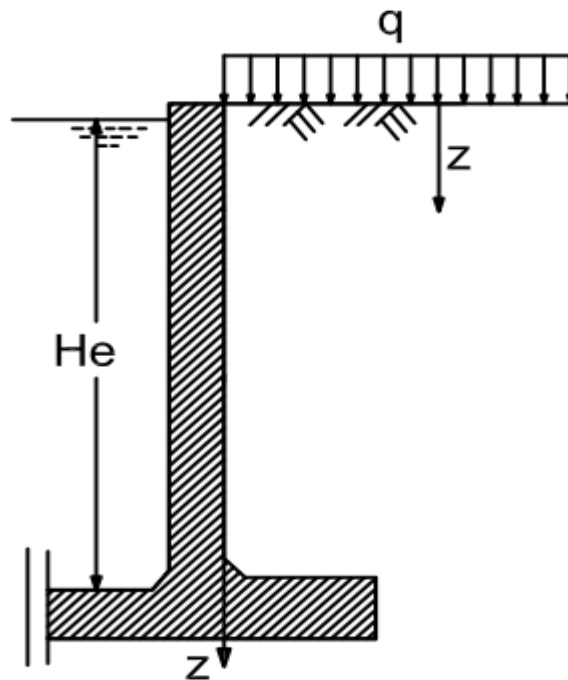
5: diagramme des poussées horizontale les dues au poids du dallage sur les parois du bassin.
